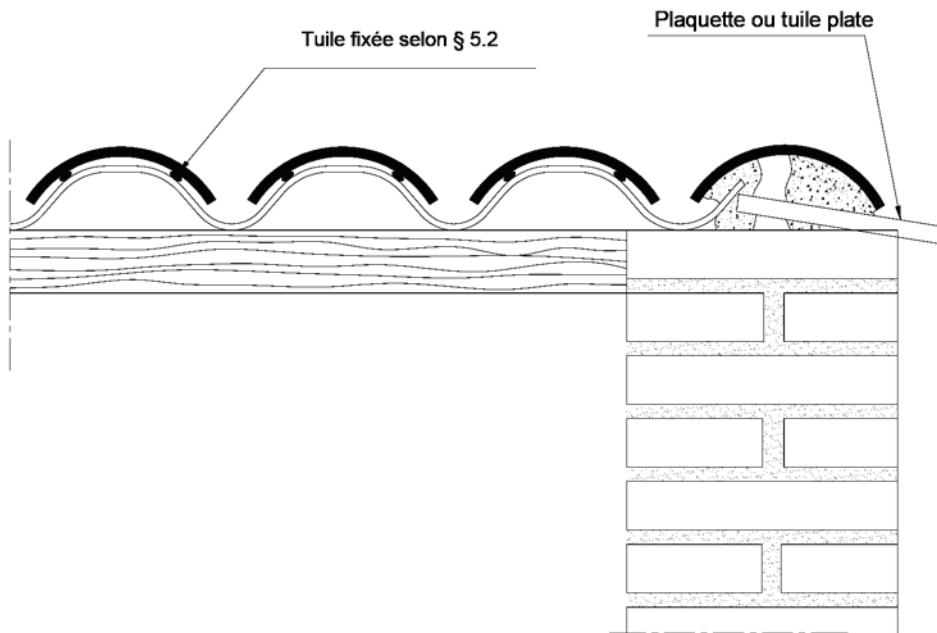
Rive latérale sur mur avec bardelis (exemple avec tuile plate ou plaquette)
